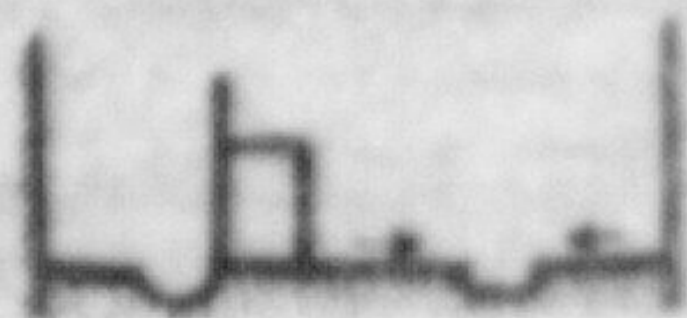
(b) - Disposition en salle longue avec deux accès d'entrée contre le mur
